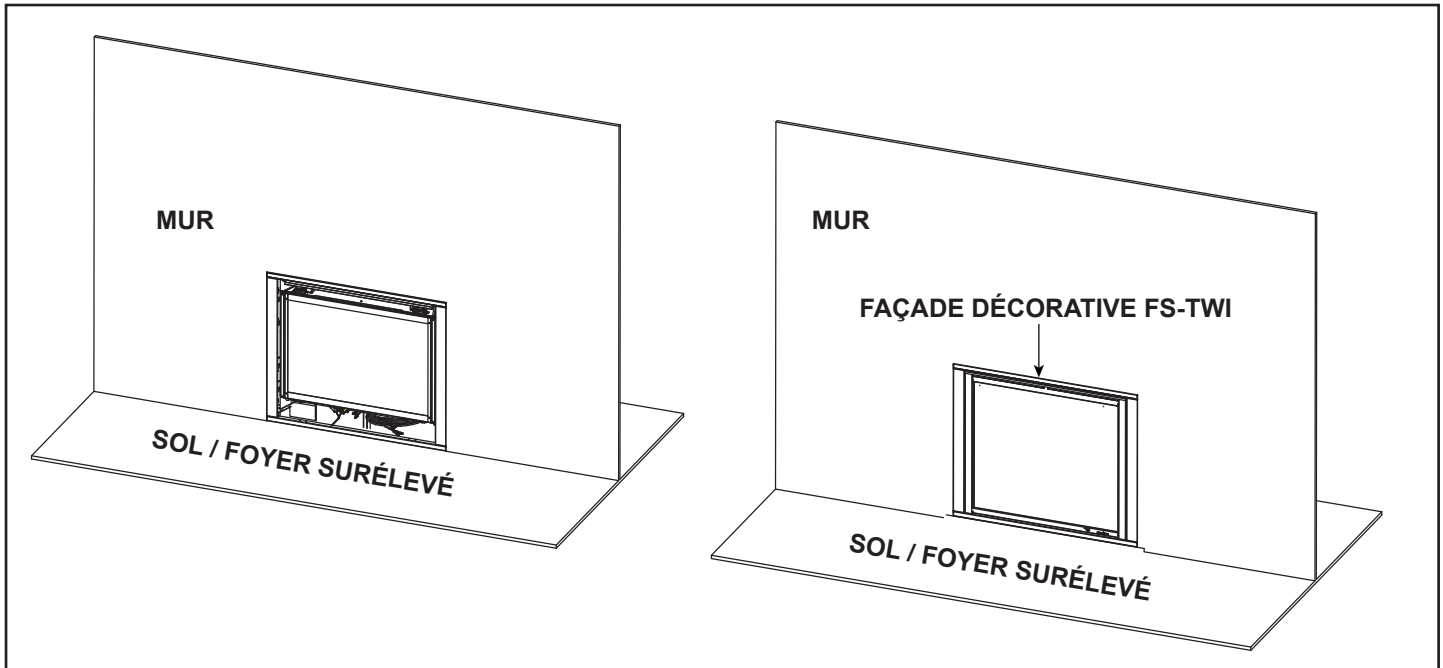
Appareil installé sur le sol ou un foyer surélevé
